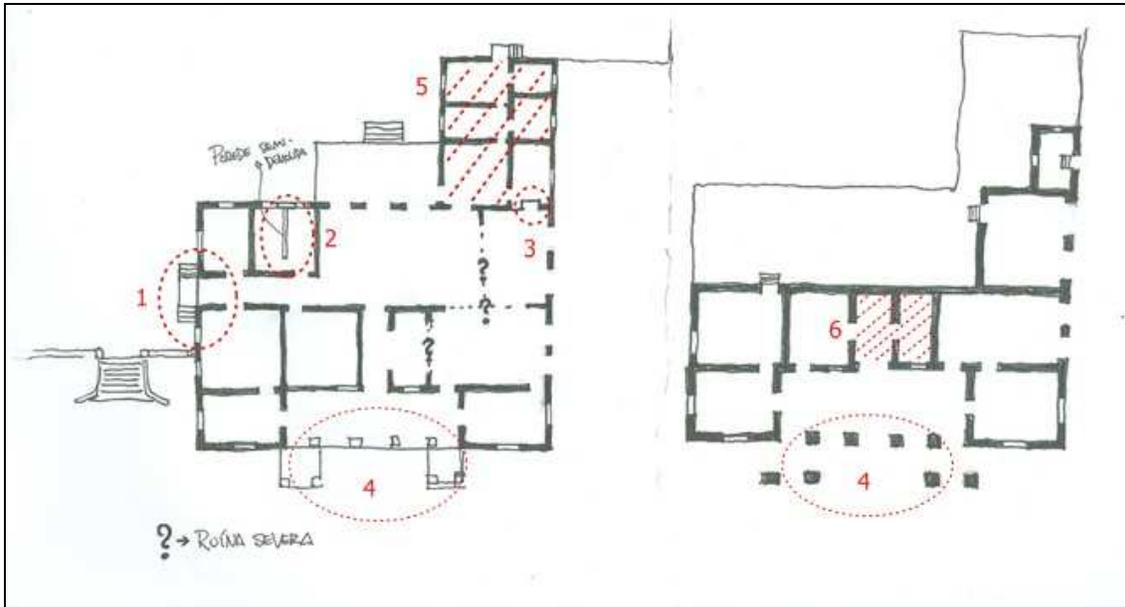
Planta atual do piso superior e térreo da Fazenda Jambeiro. Estão indicados os locais que sofreram maiores alterações da planta original. (1) escada de acesso ao corredor dos quartos, provavelmente construída depois da retirada da escadaria principal; (2) parede recente dividindo o cômodo, com resquícios de azulejos, possivelmente foi construído um banheiro; (3) reentrância não identificada; (4) antiga frente do edifício onde originalmente se localizava a escadaria; (5) área de serviço e cozinha, local que mais sofreu alterações e reformas; (6) cômodo onde atualmente é possível identificar local de banho, mas que destoa do edifício original.
